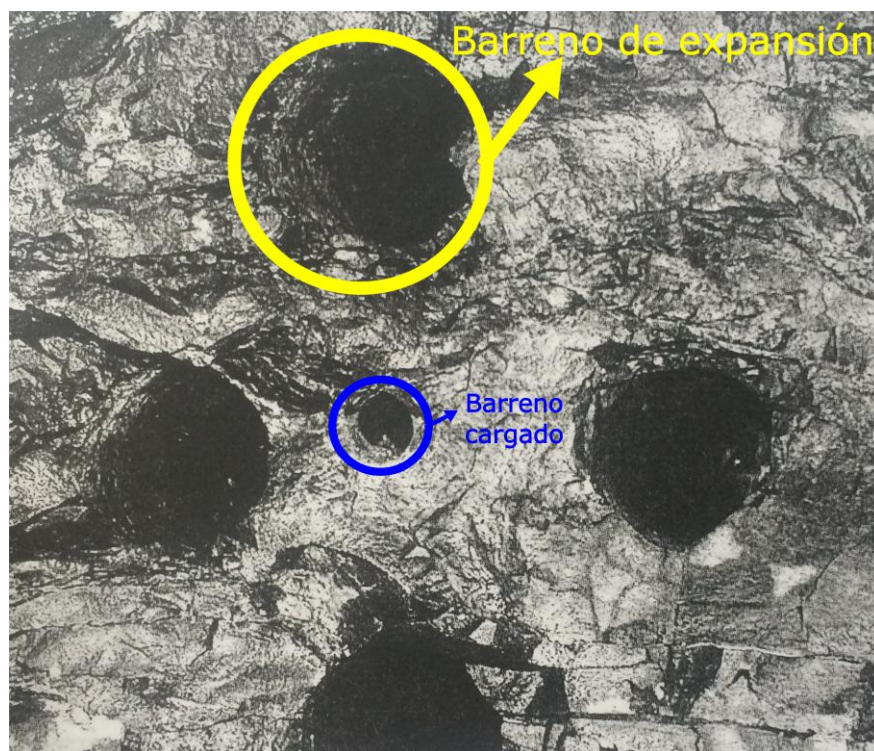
Barrenos de expansión y barreno cargado (modificado de (68)).
